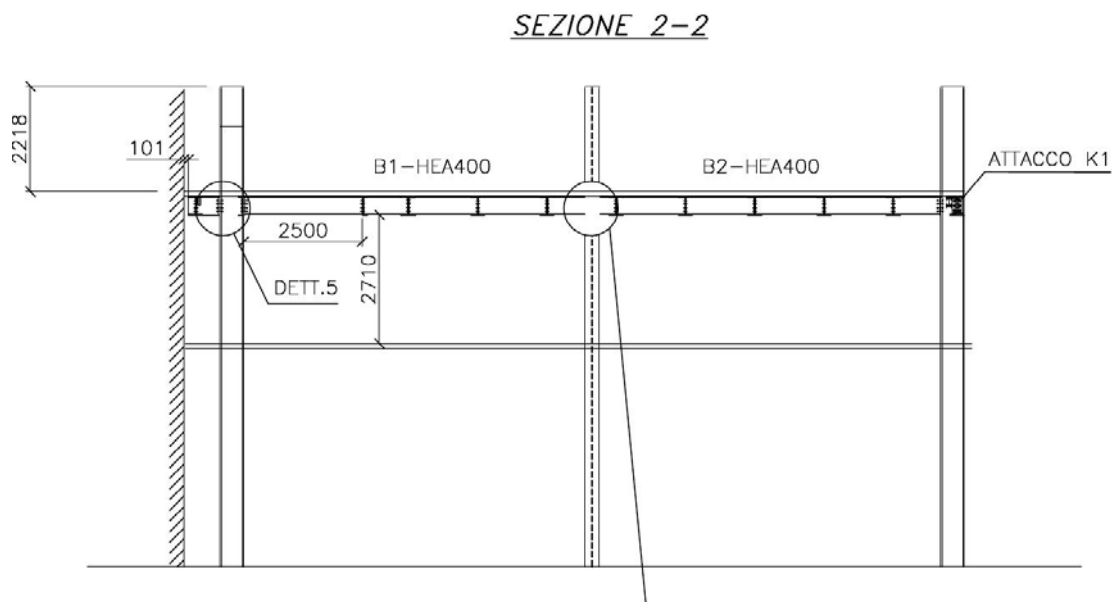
Particolare di A.2007.a.sa.T01 - Progetto della struttura - Prospetto Est
